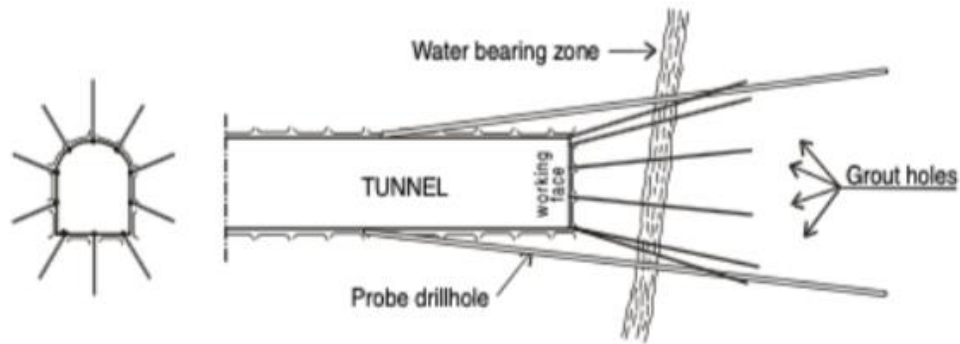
Esquema de sondajes en el frente de excavación y perforaciones de grouting.
